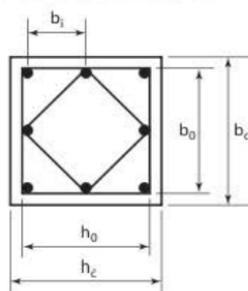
Confinement d'un poteau rectangulaire
